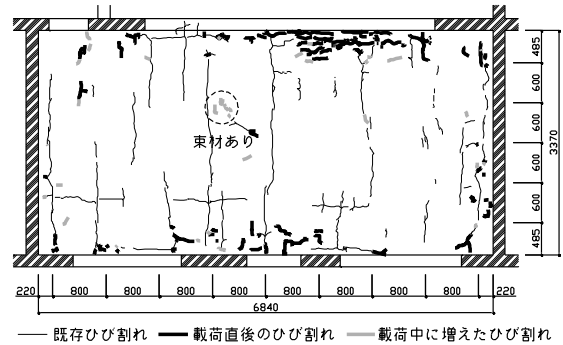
スラブ上面のひび割れ状況(工法1)
